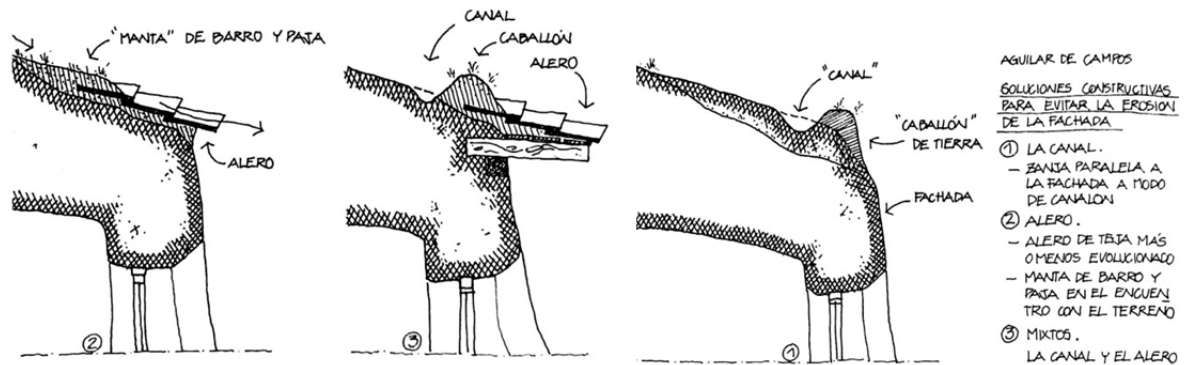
Tipos de soluciones para proteger la fachada. Félix Jové.
